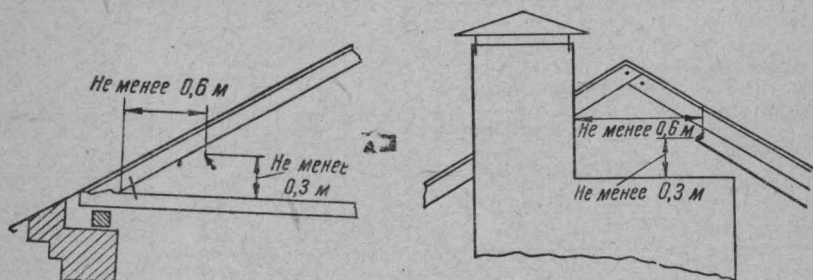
Расстояние под спринклерами в верхнем перекрытии.
